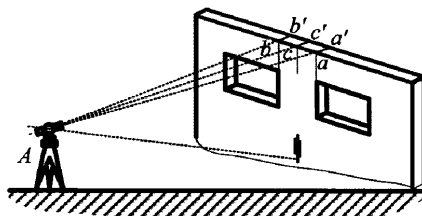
Схема переноса монтажных осей на верхние ярусы (монтажный горизонт) сооружения
